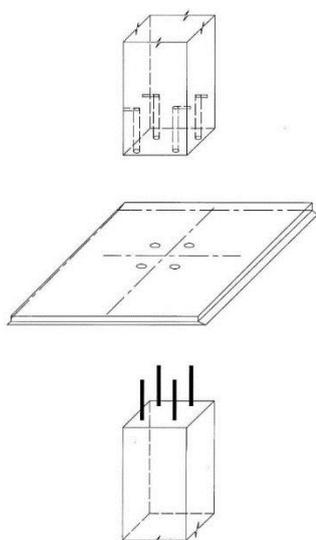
Штепсельный стык колонн и надколонных плит перекрытия
